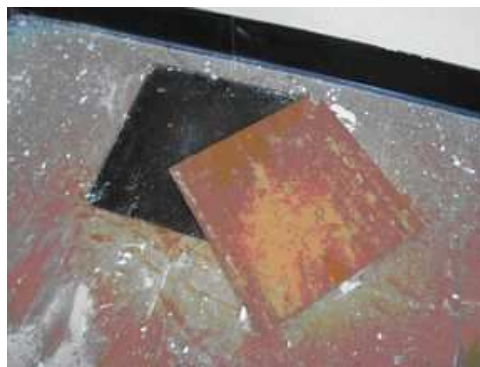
Dalles vinyles « flammées » fixées par de la colle noire amiantée sur le sol (les dalles sont plus souvent verdâtres)
